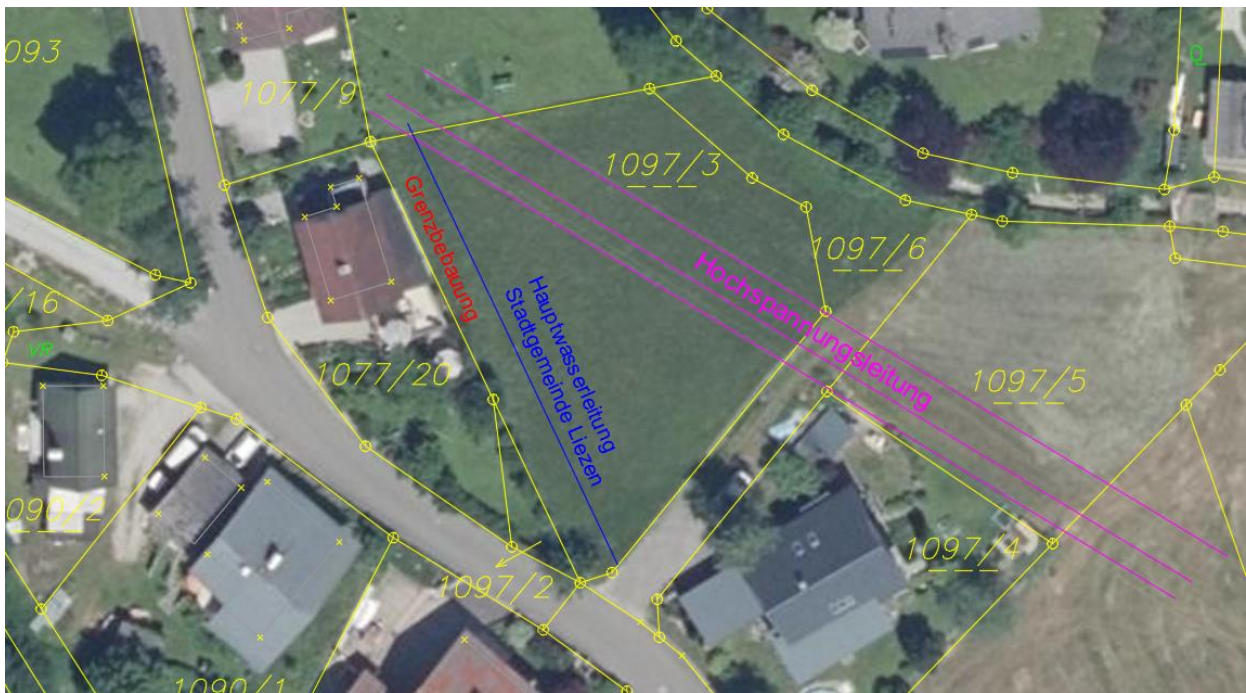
Lageplan auf Grundlage des Katasters mit der Hauptwasserleitung, der 110 kV Hochspannungsleitung und der vorhandenen Grenzbebauung
